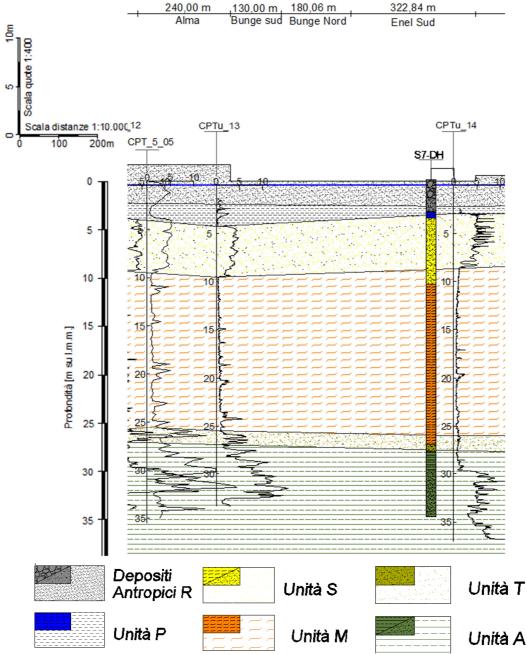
Profilo delle unità geotecniche nel tratto di interesse
